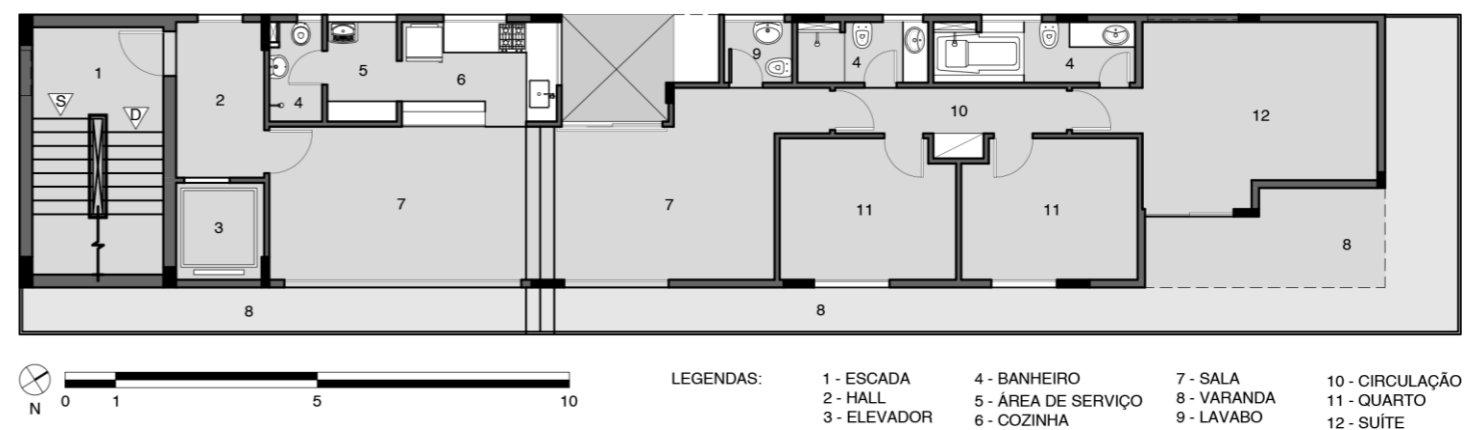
Planta do quinto pavimento do Montevidéu 285
